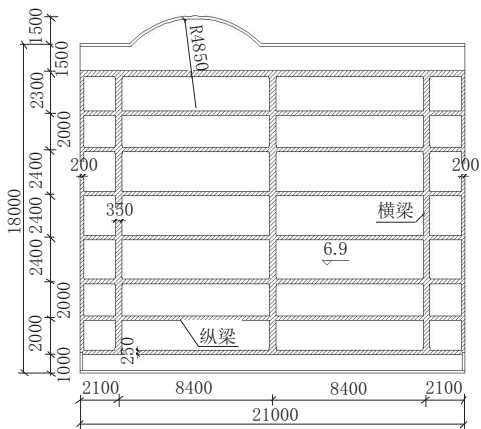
外滩空箱式防汛墙顶部结构平面图(单位:mm)
